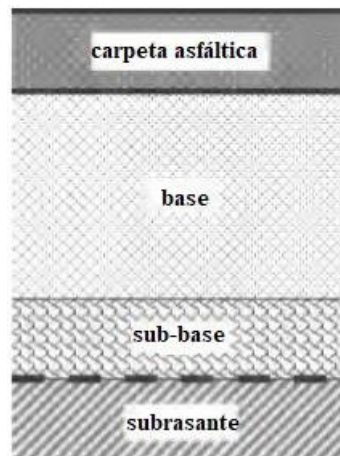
Estructura de un pavimento flexible. Fuente: Elaboración propia a partir de (Papagiannakis et al., 2008)
